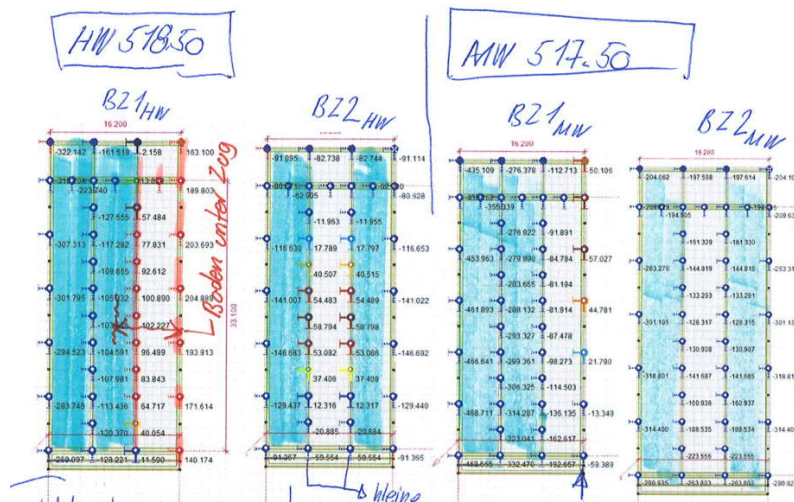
Belastungsschema; Grundriss Beckenblock VKB («blau» Becken mit RWSP)
